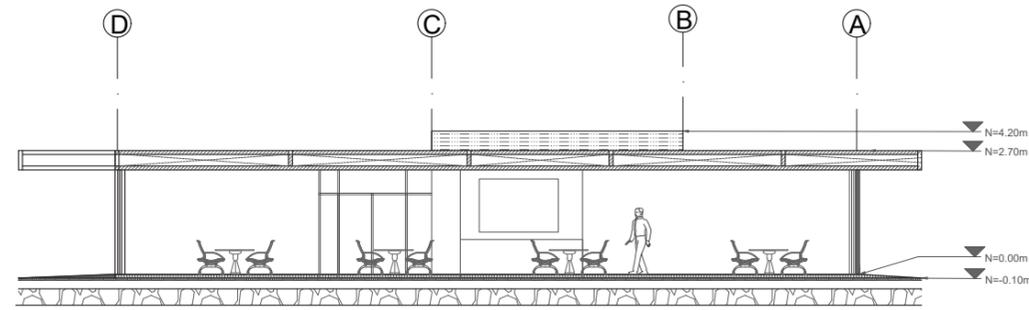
PLANIMETRÍA\_SECCIÓN A-A
